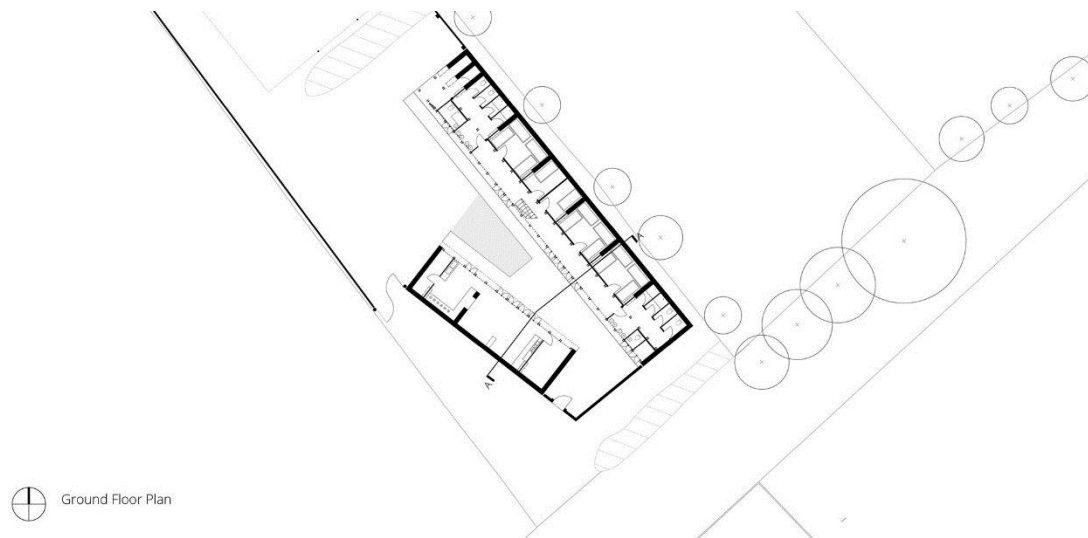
, 43, 44 | VISTA DO PÁTIO, PLANTA E INTERIOR DO CENTRO - NAKURA | IN: WWW.ARCHDAILY.COM/
